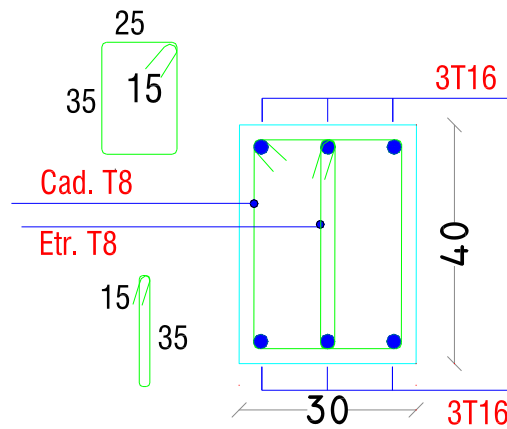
Ferraillage des poutres principales pour RDC.
